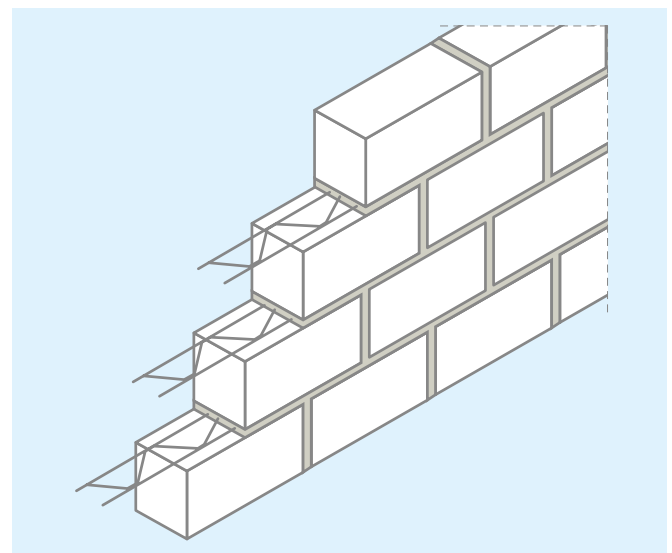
Lagerfugenbewehrung zur konstruktiven Risssicherung
